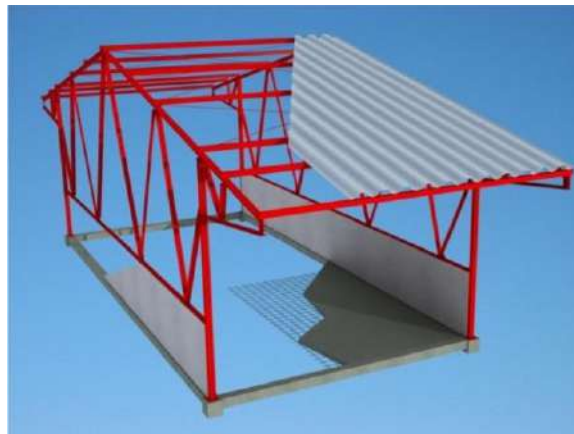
sistema constructivo pórticos metálicos republicano. Bodega del Ferrocarril
